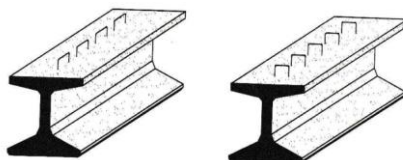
Esquema da armadura de reforço para o esforço de corte entre as vigas e a laje do tabuleiro (FIB, 2004)
